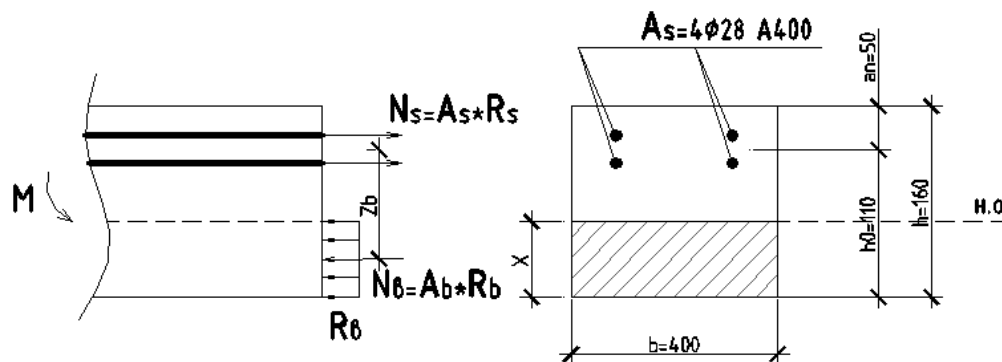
Схема внутренних усилий мнимой второстепенной балки на опоре
